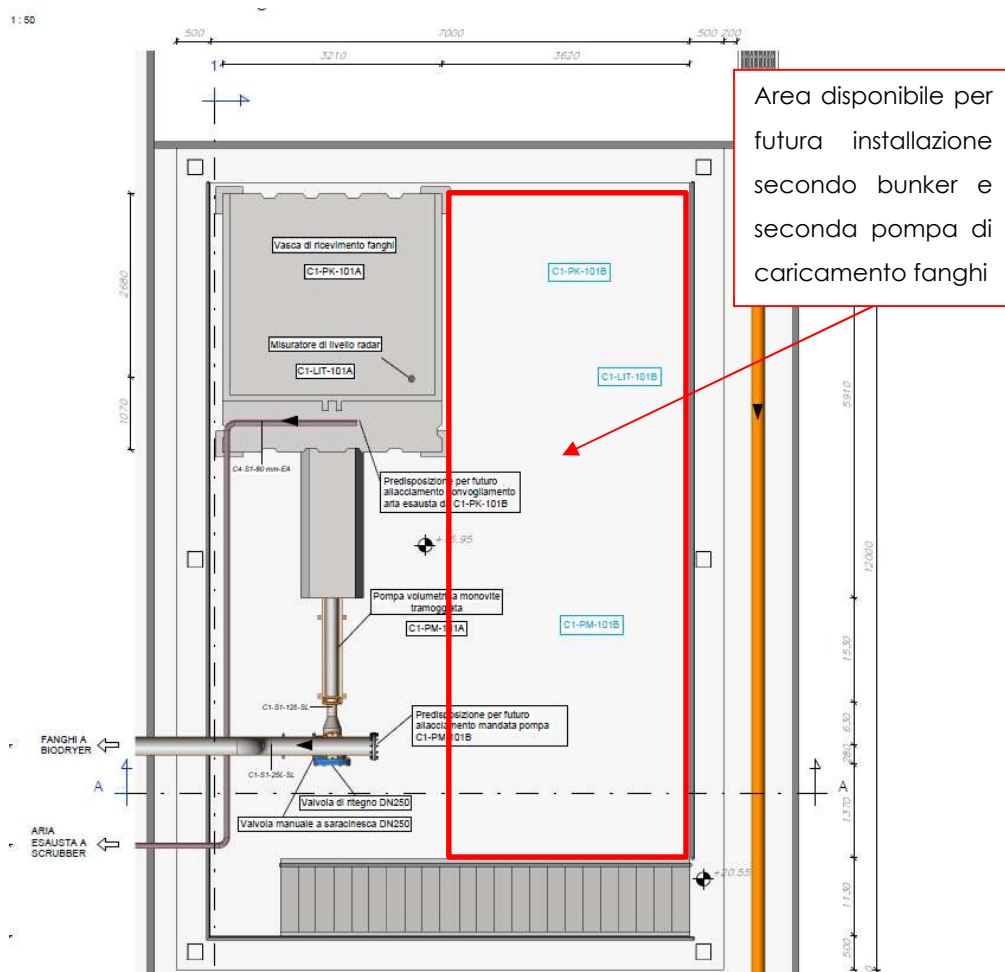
Vista planimetrica dell'area di scarico e stoccaggio fanghi disidratati
